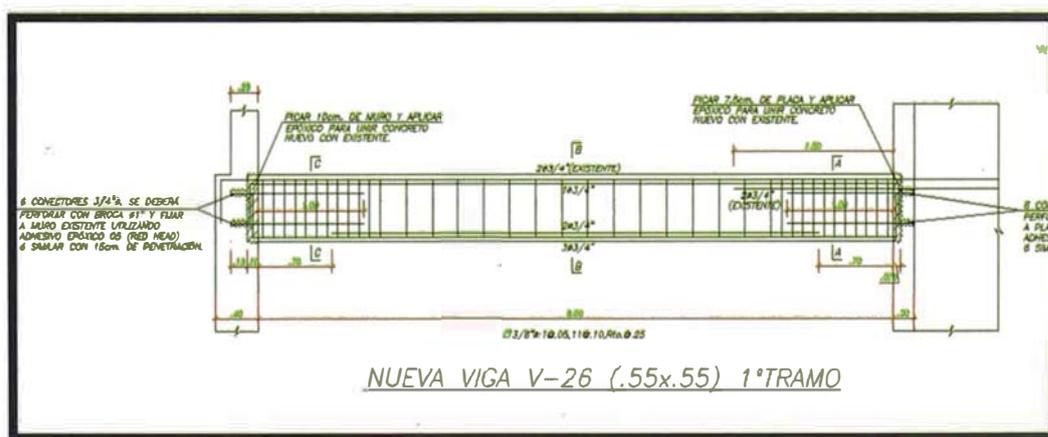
Detalle de cambio de viga ingreso a sótanos.
